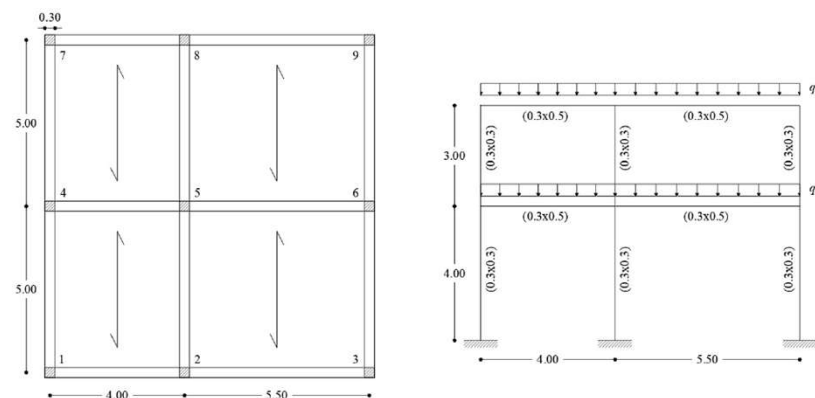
Geometria della struttura di c.a. (dimensioni in m).
